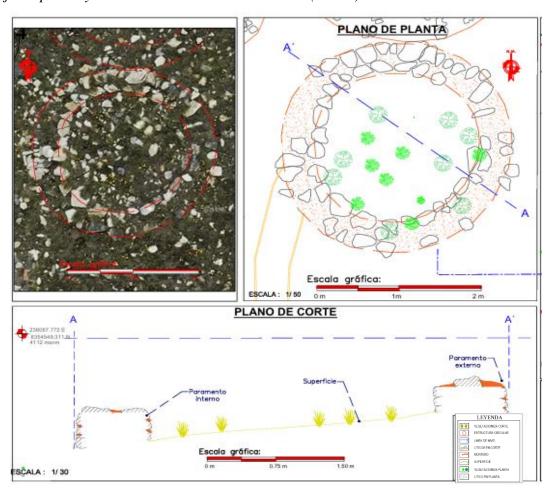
Dibujo de planta y corte de la Estructura domestica (Ed-52)
